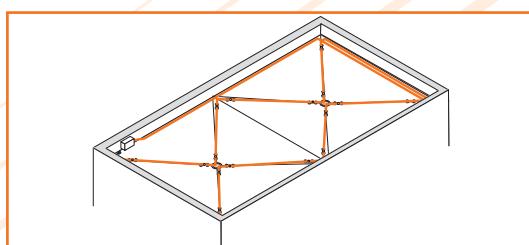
Схема размещения крепежных скобок на плоской кровле
